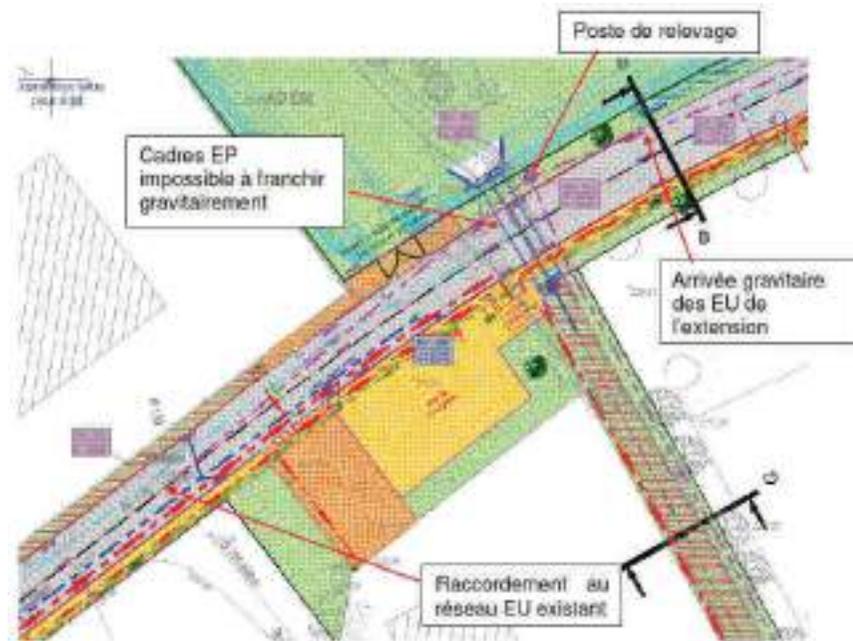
Relevage des eaux usées au droit des cadres de traversée de la voirie pour les eaux pluviales
